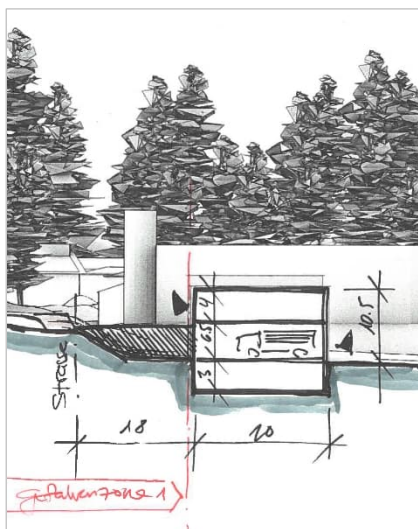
Schnitt und Ansicht Variante B, mit Aufschüttung, zwei befahrbare Ebenen sind möglich.
